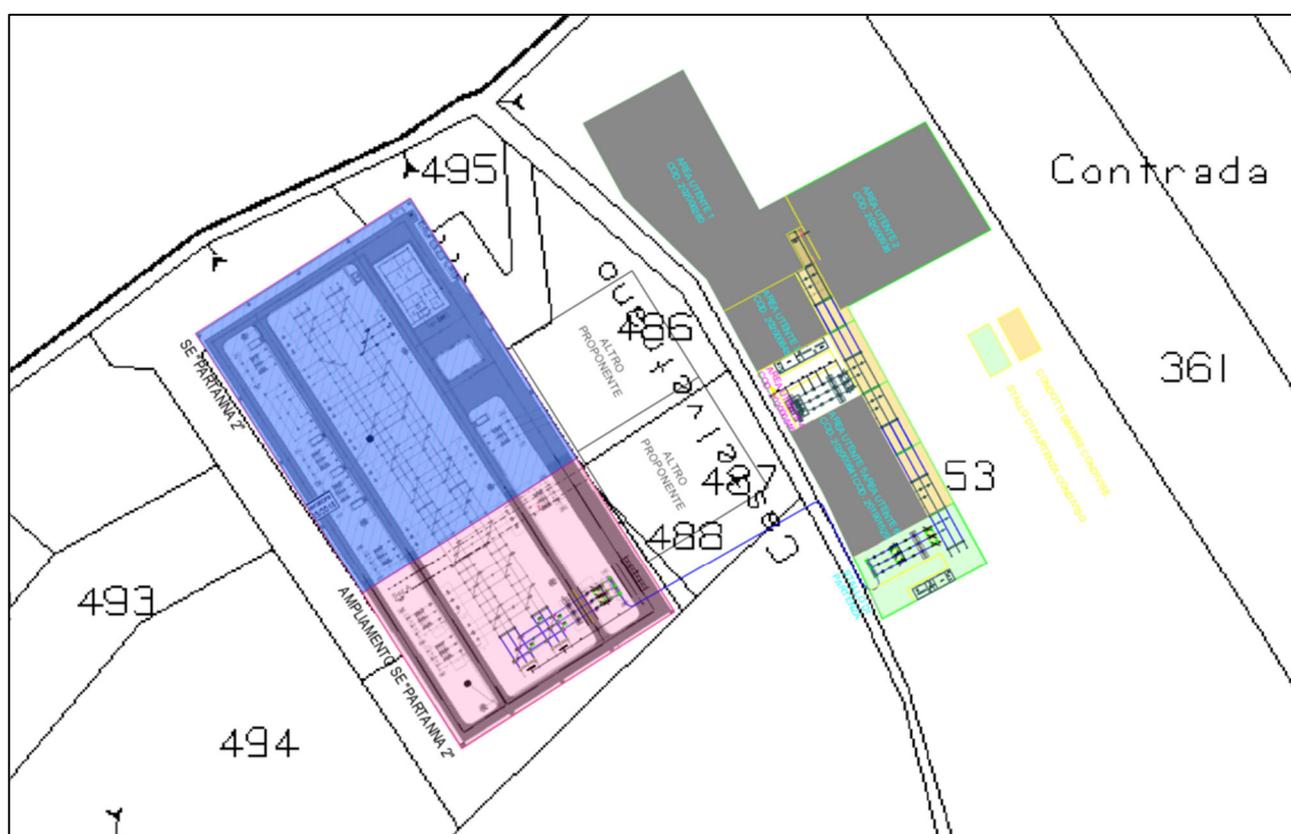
Planimetria elettromeccanica stazione elettrica condivisa
